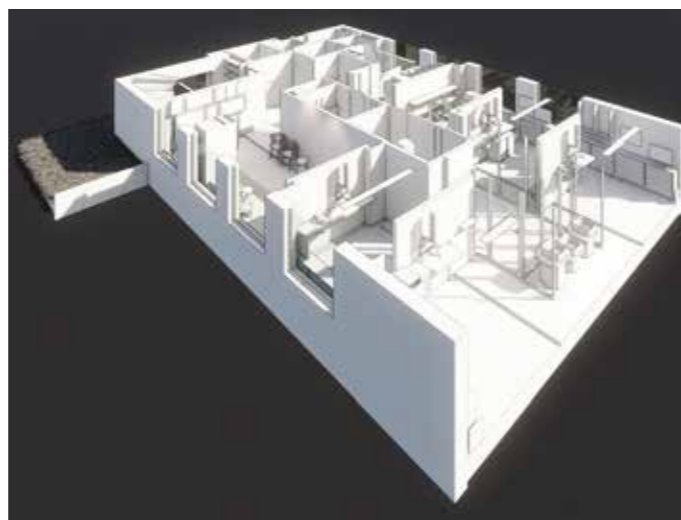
Il modello del progetto (RVT + Enscape) pronto per la navigazione VR - courtesy BIMteam UK
